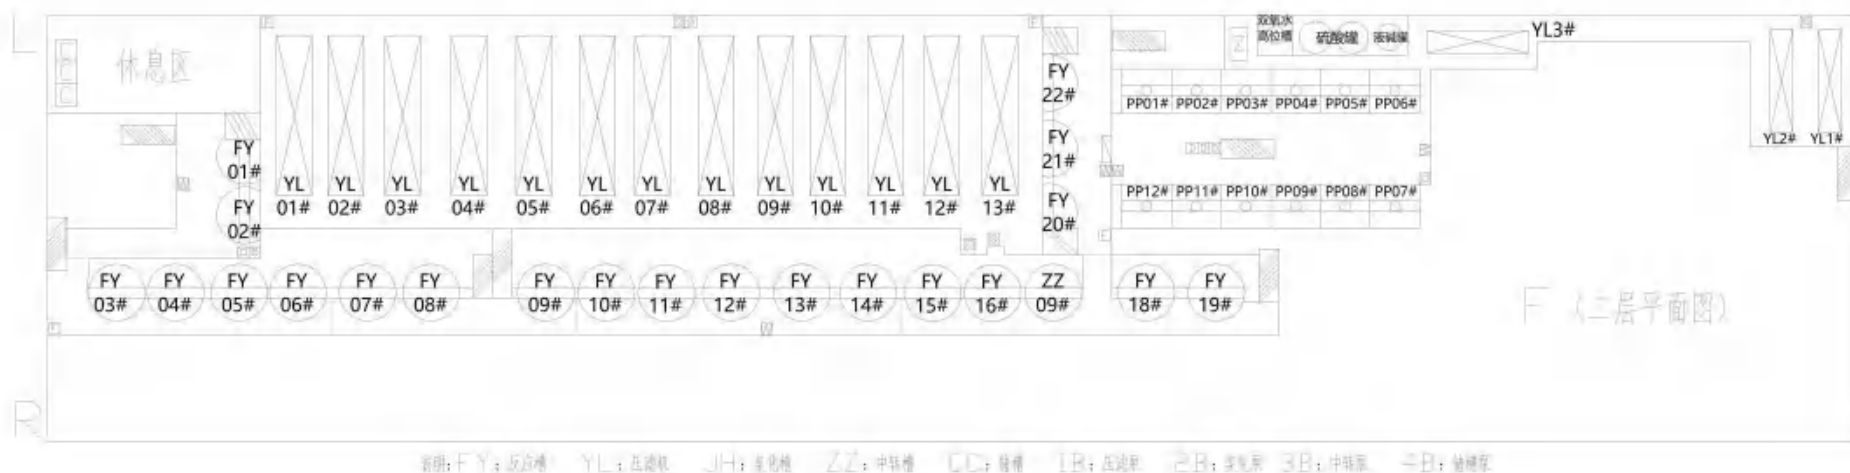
浸出二车间设备设施平面布置图 (2 楼)
